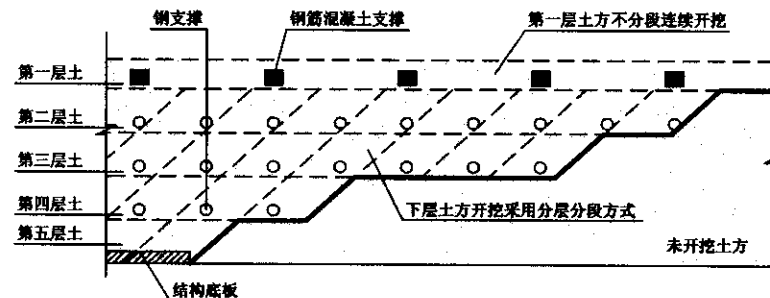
第一道支撑采用钢筋混凝土支撑的基坑斜面分层分段开挖方法
